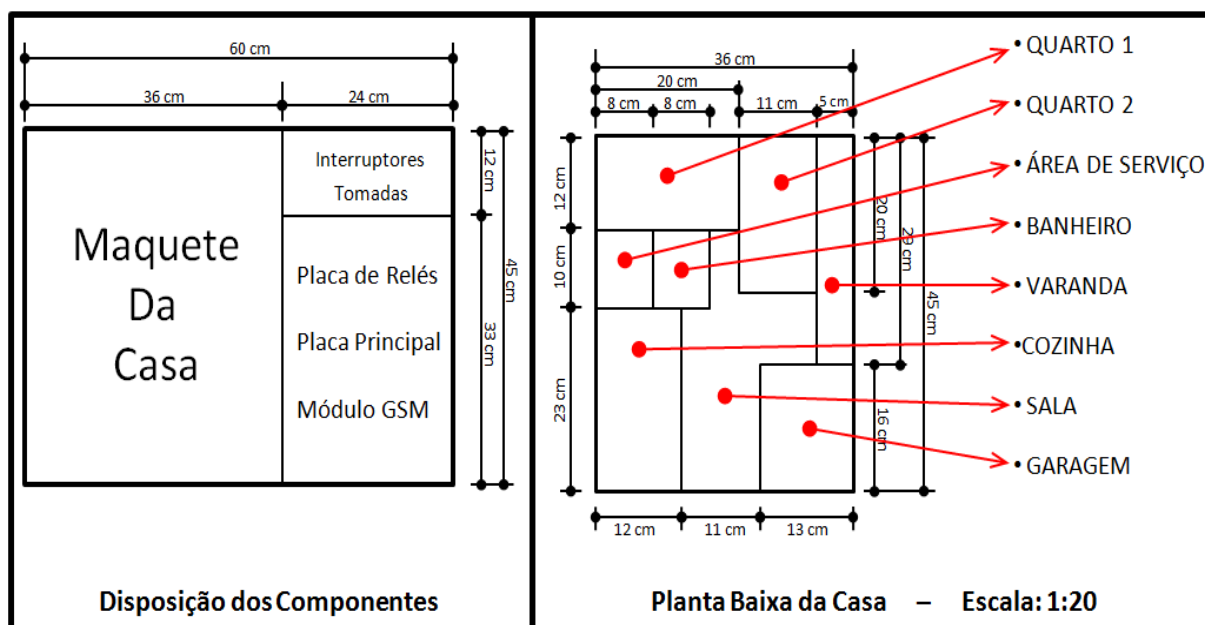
Disposição dos Componentes e Planta Baixa da Casa (AUTOR)
